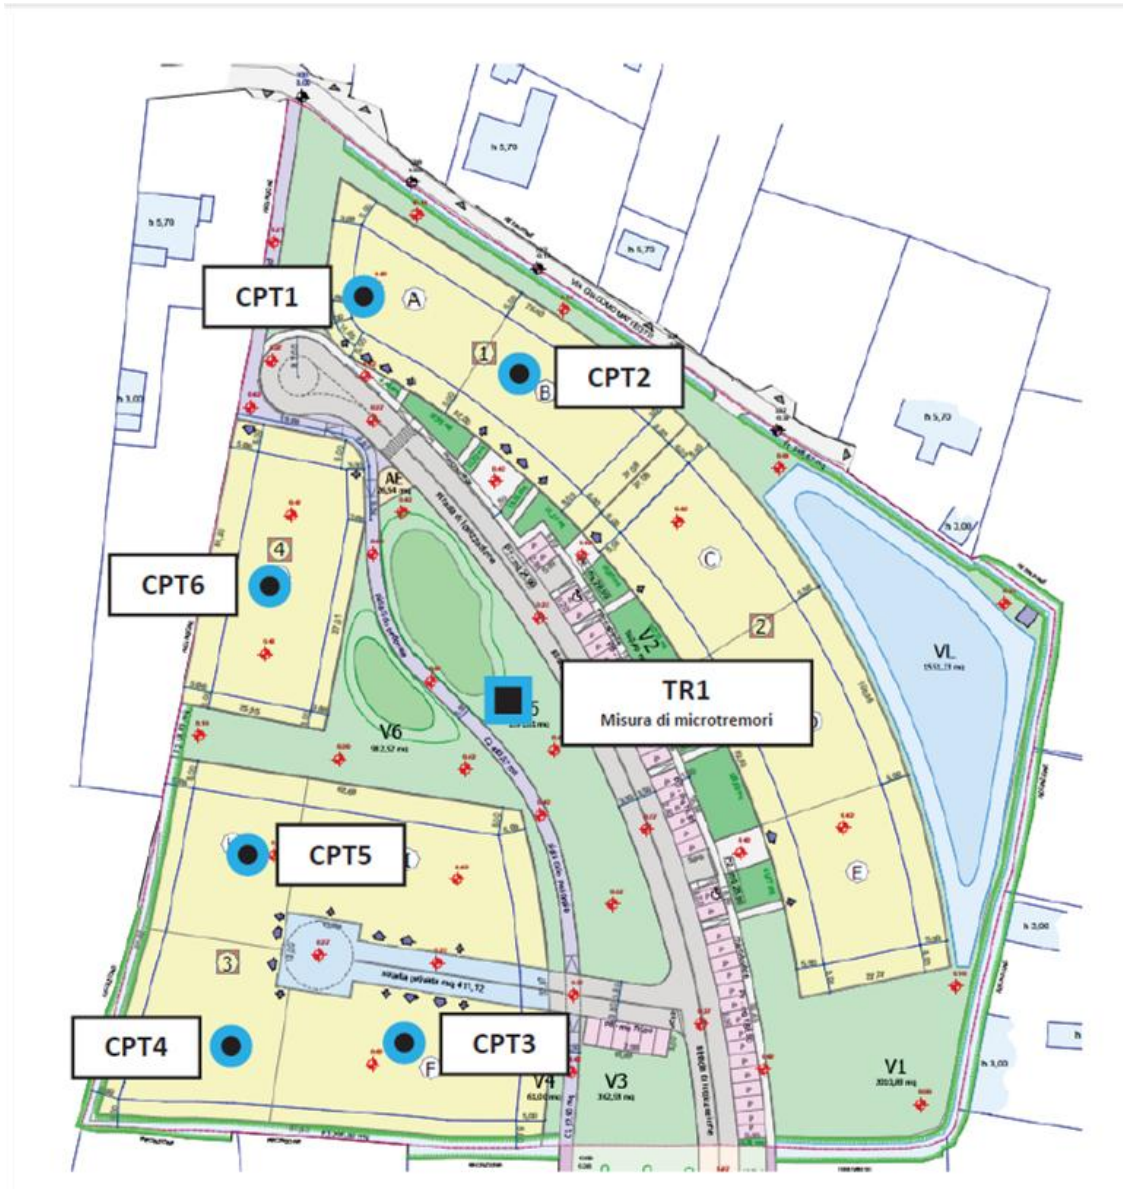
Planimetria di progetto con l'ubicazione dei sondaggi eseguiti.
